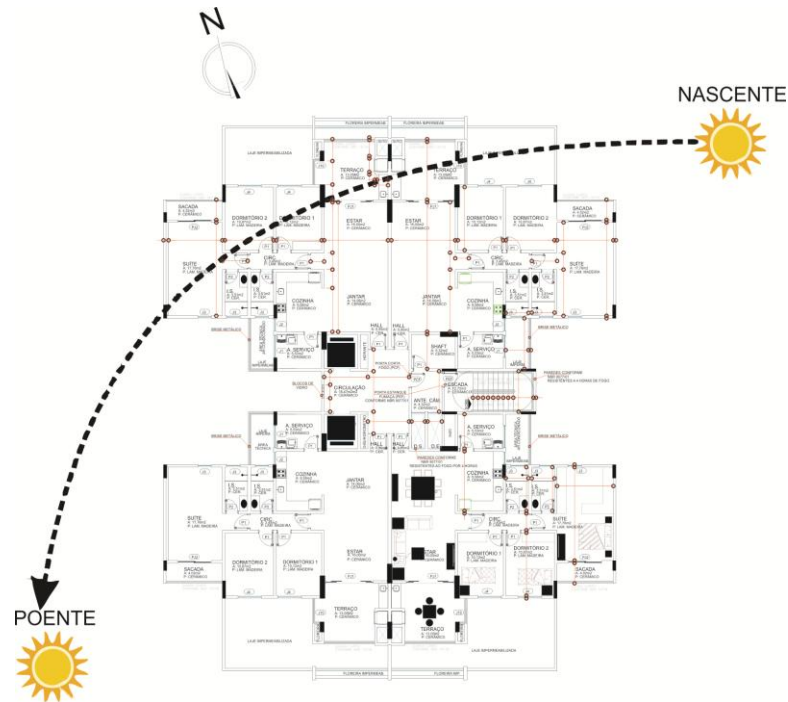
Demonstração Iluminação no Pavimento Tipo.
